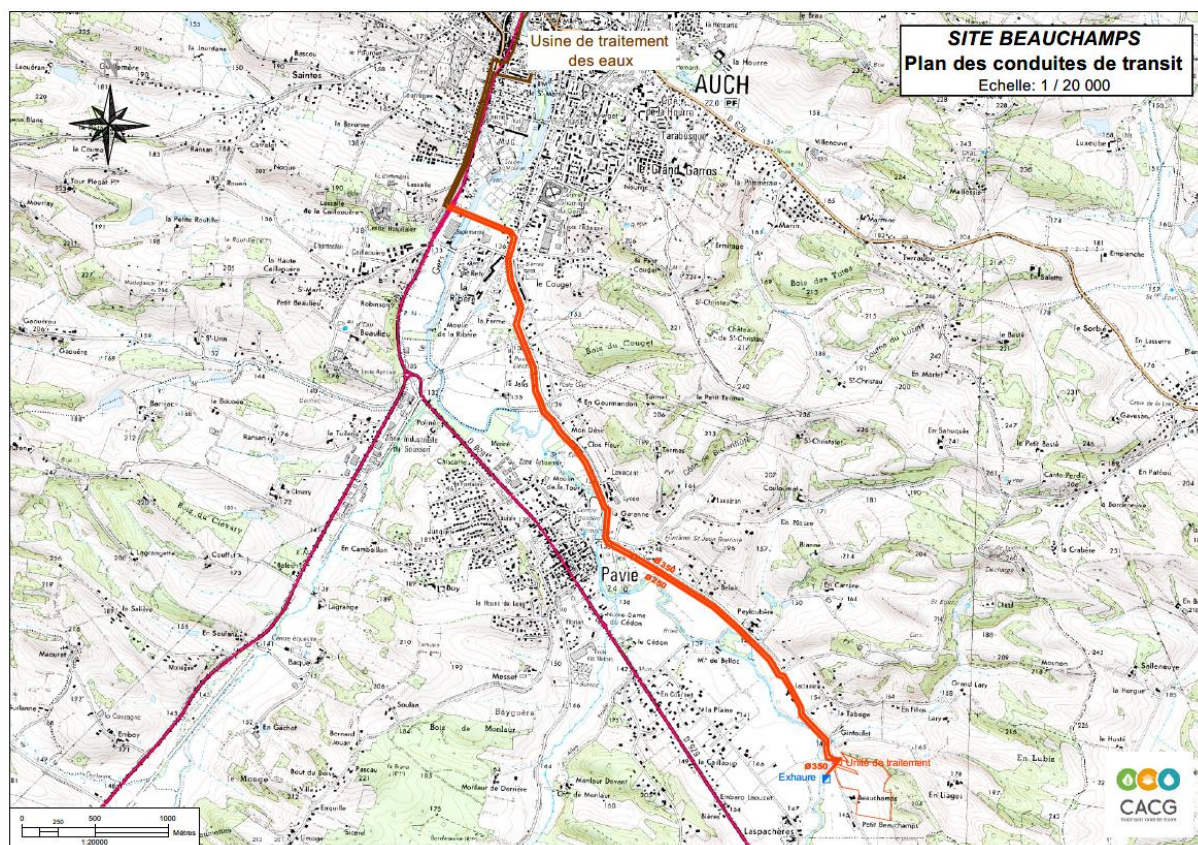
Plan des conduites de transit pavié - Source : CACG
